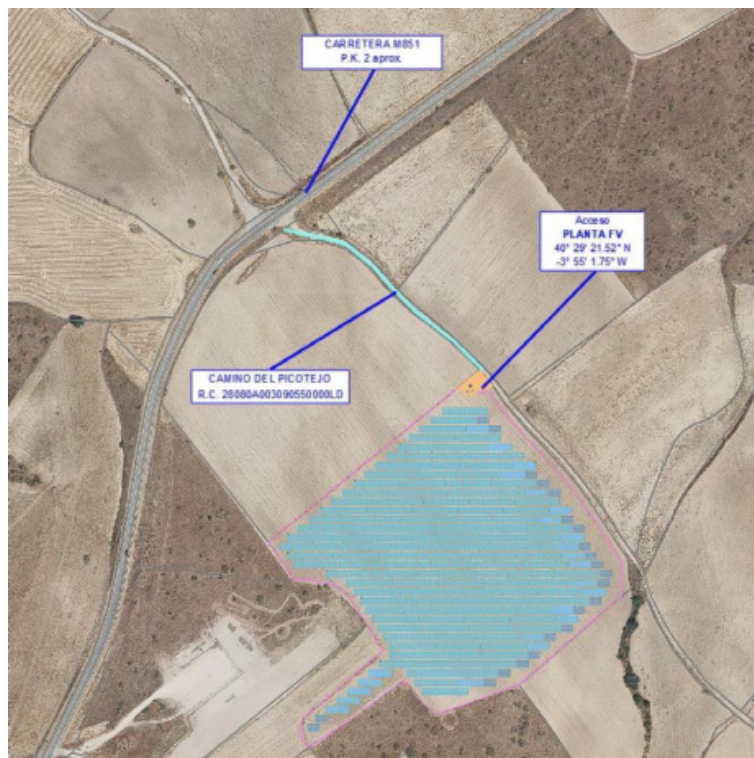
Figura acceso a la PF Majadahonda. Fuente: Proyecto de ejecución administrativo Planta fotovoltaica para conexión a red “PF Majadahonda” (Renerix Engineering, 2024).
